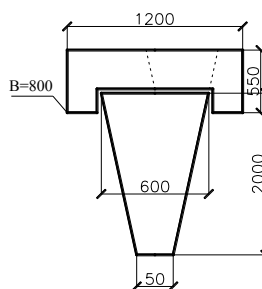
Пірамідальна палія зі збірним залізобетон. оголовком
